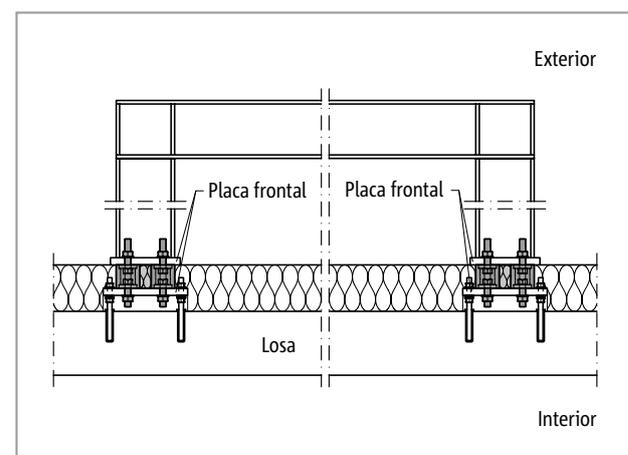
Schöck Isokorb® T tipo S-V: conexión de marco rígido para construcciones secundarias (se deberán tener en cuenta momentos adicionales por imperfecciones)
